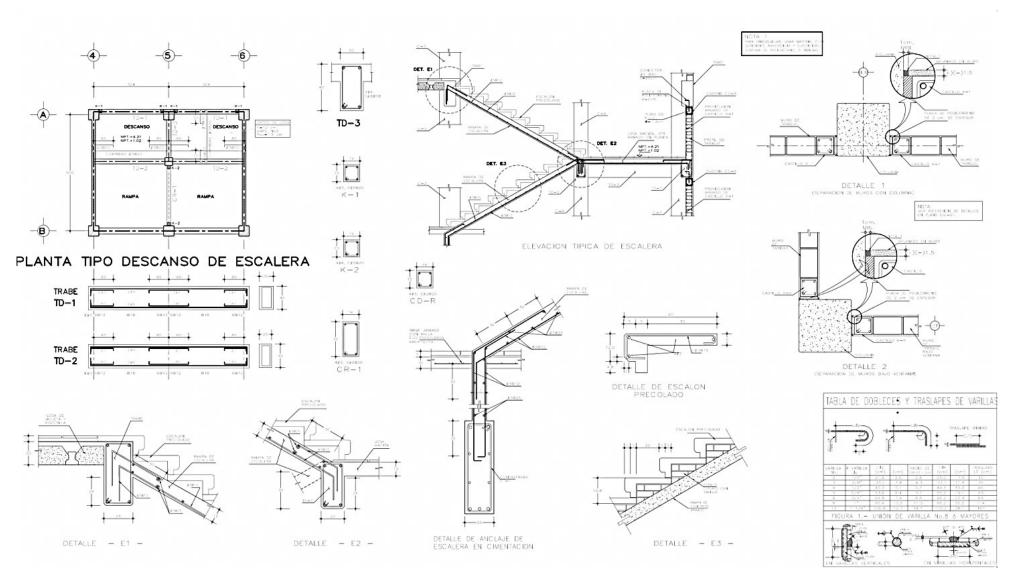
Detalles de escalera (Dependiendo del tipo de escalera y solo sí se cuenta con ésta)
